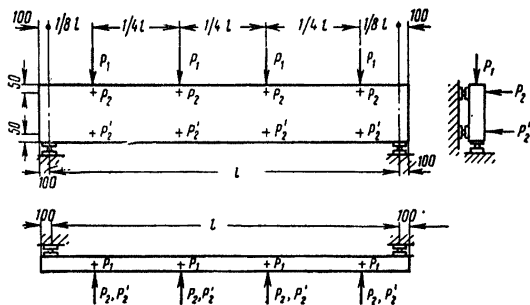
Схема приложения нагрузок при испытании стеновых панелей
